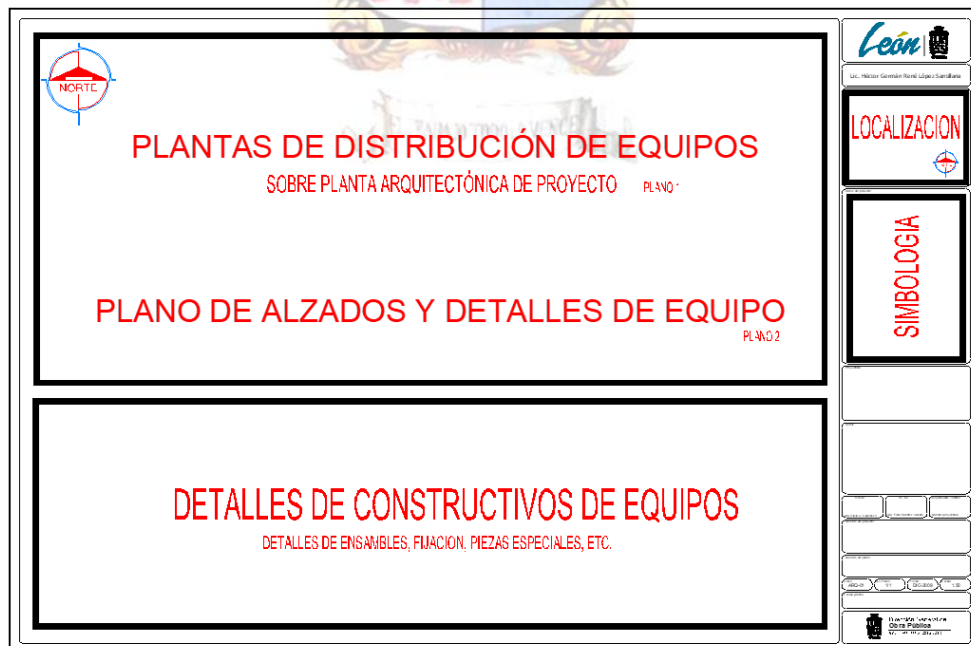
Plano llave para proyecto de cancelería y herrería
